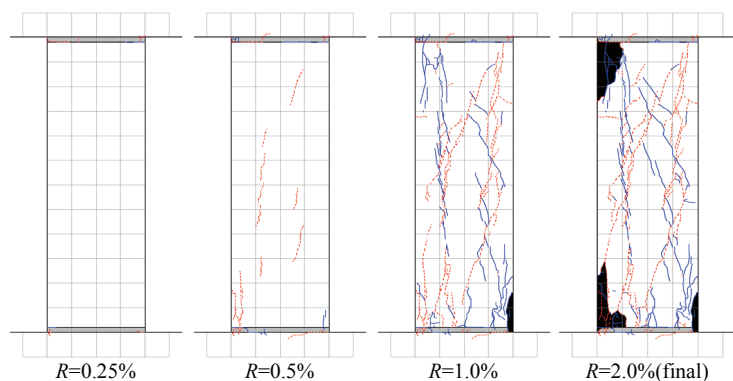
B1/2-0.1 ひび割れ状況
